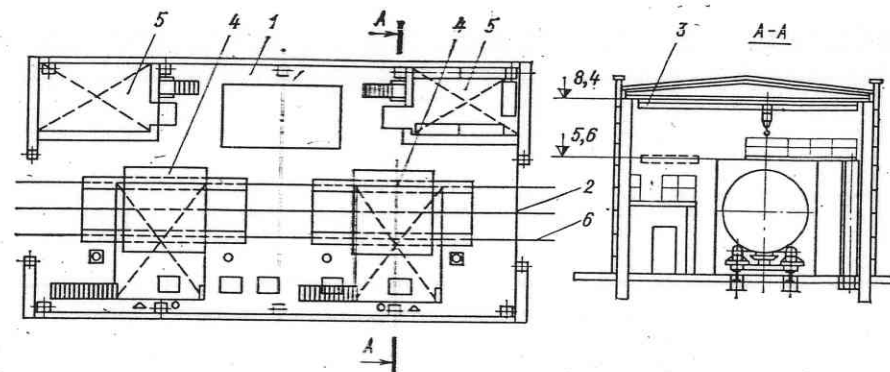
Цех сварки звеньев турбинных водоводов II типа:
